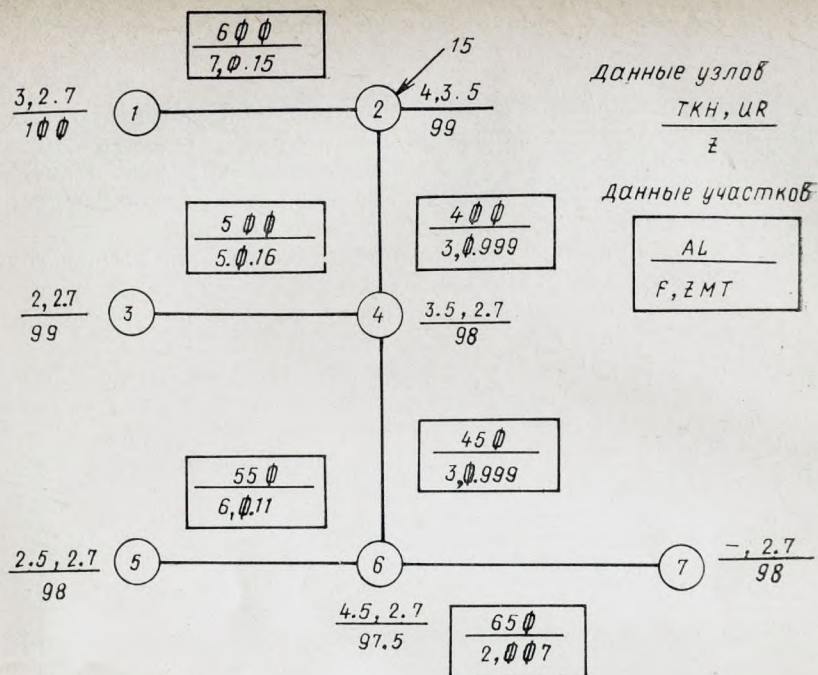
Схема дождевой сети, подготовленная к расчету на ЭВМ
